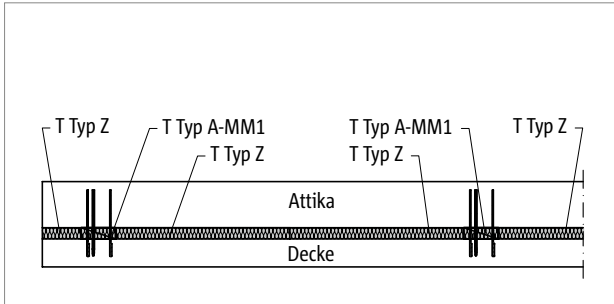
Schöck Isokorb® T Typ A, Z: Attika (T Typ A-MM1)
